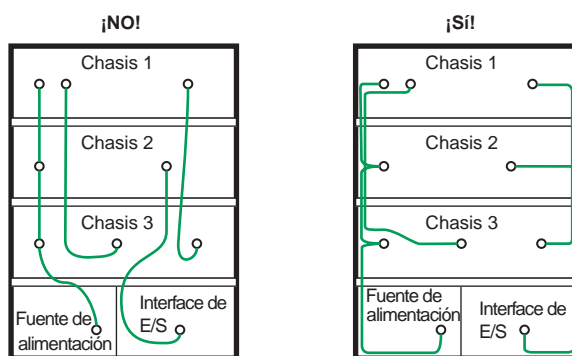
Tendido de los cables en toda su longitud junto a las piezas metálicas conectadas.
